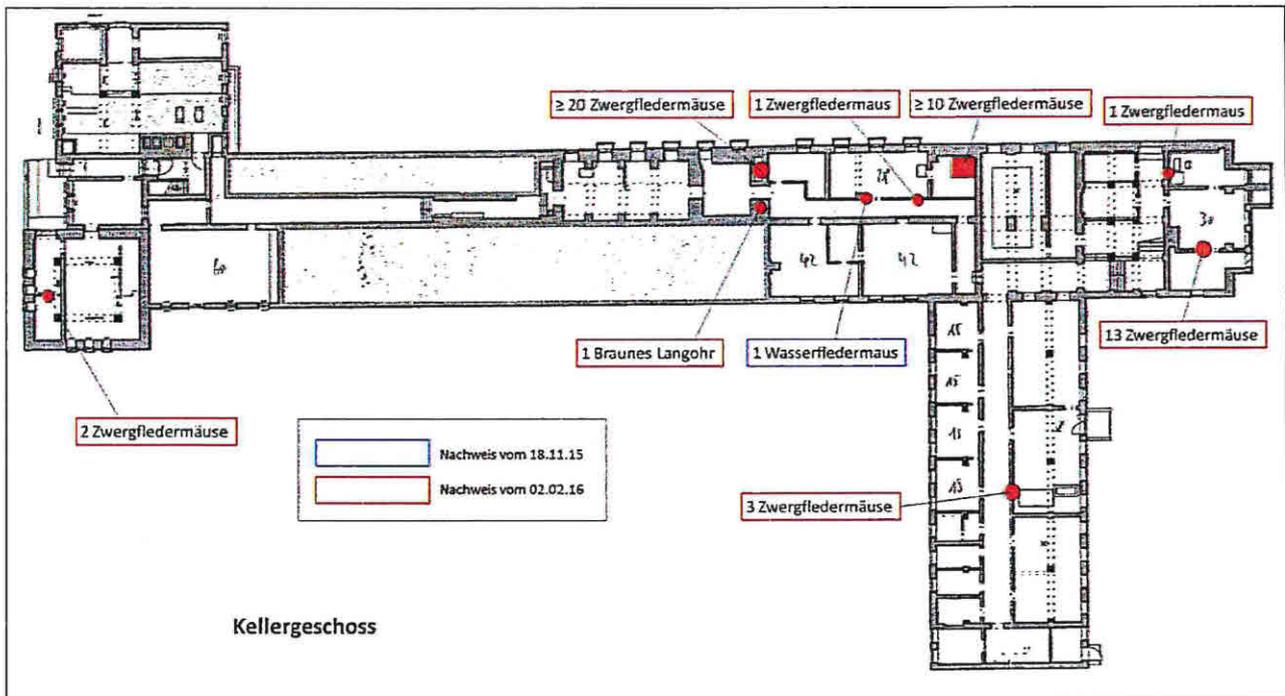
Nachweise überwinternder Tiere im Kellergeschoss.
